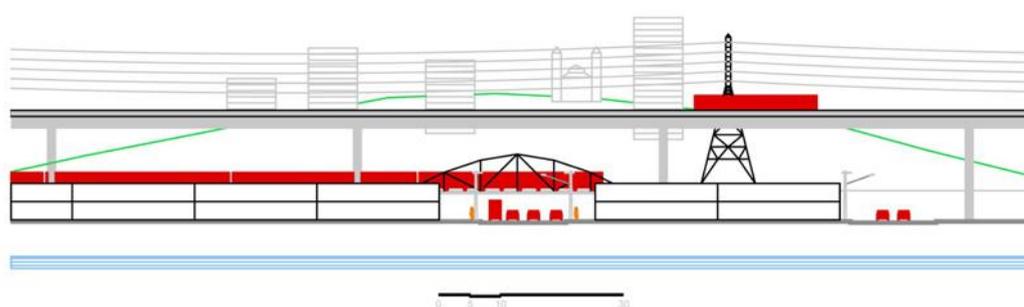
Situação 9 – Complexa: Colina da Penha (fonte: Google Street View e autores).
